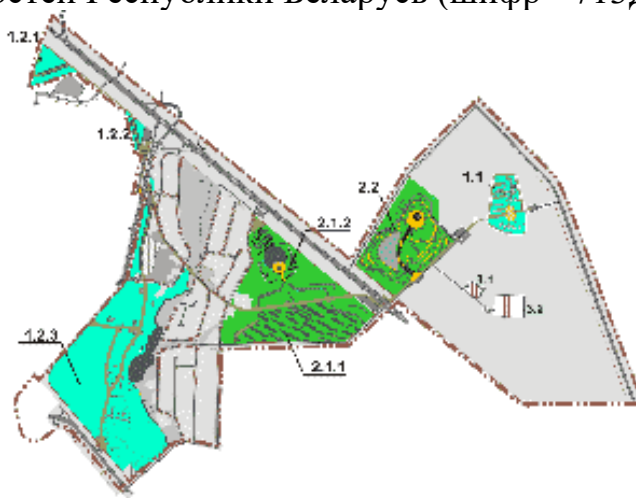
Схема генерального плана Мемориального комплекса «Тростенец»
